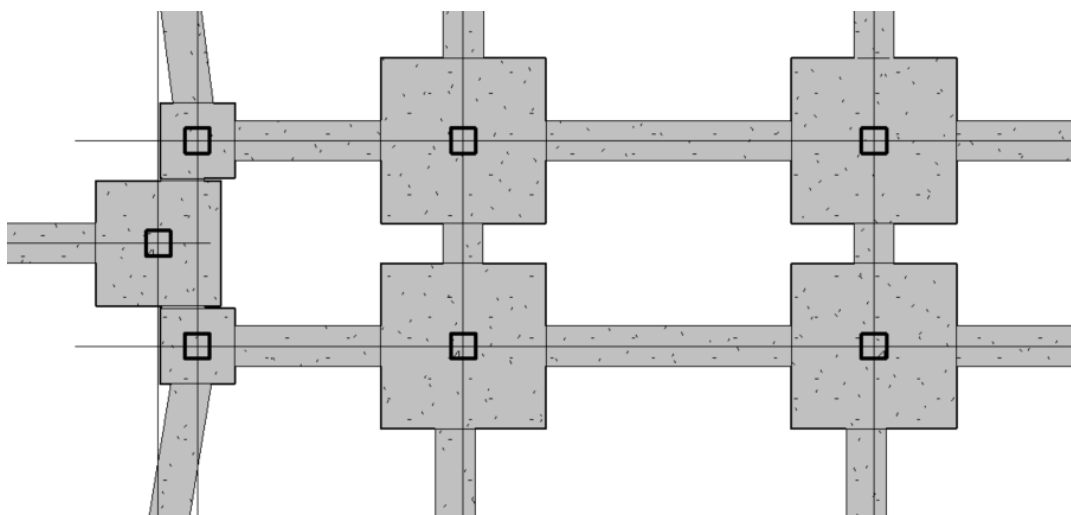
Vista en planta de la solución propuesta para realiarle el análisis estructural
